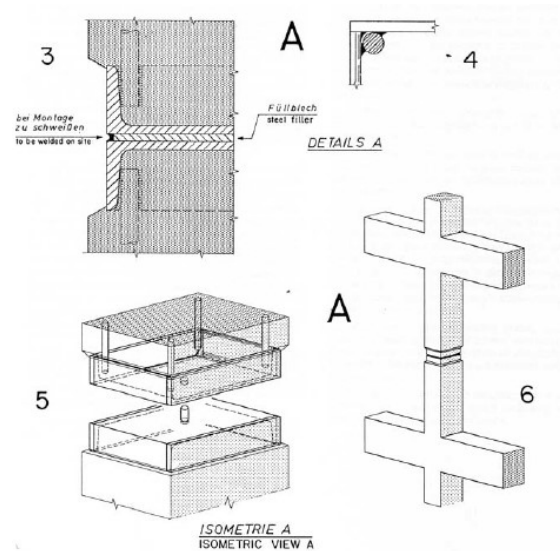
Ligação por soldagem de perfis na face (Stupré, 1981)
